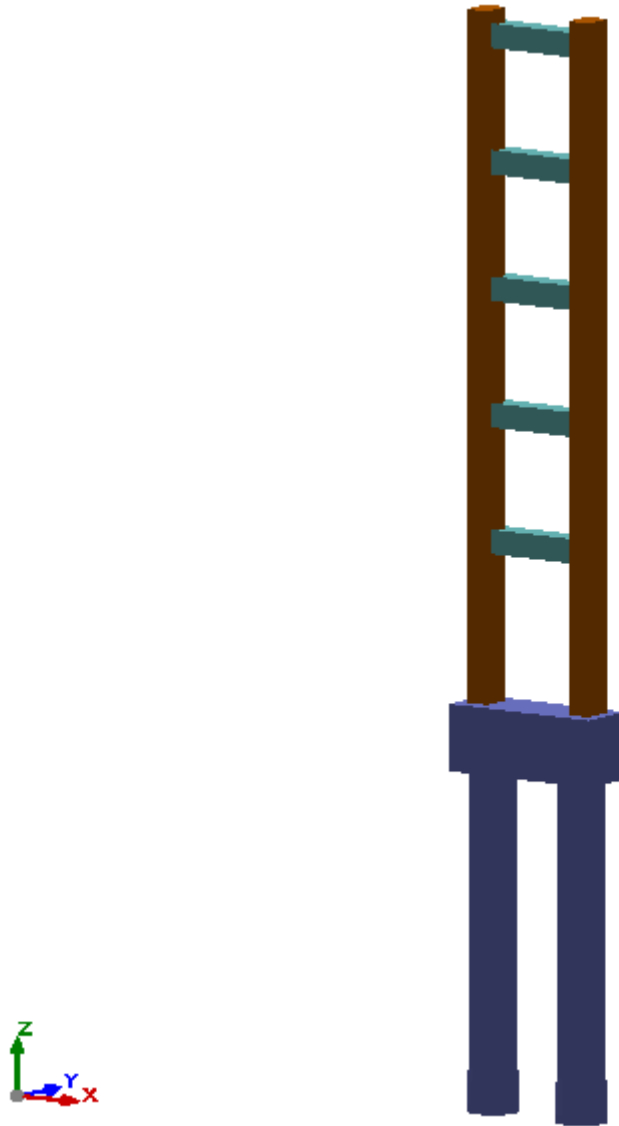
Vista isométrica da torre em concreto armado da Passarela Pênsil sobre o Rio Tietê.
